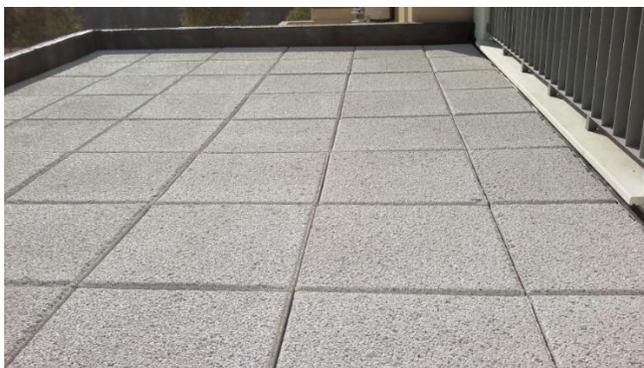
Cubiertas de Losa Infiltrante. Tomado de <http://www.ipvc.es>
